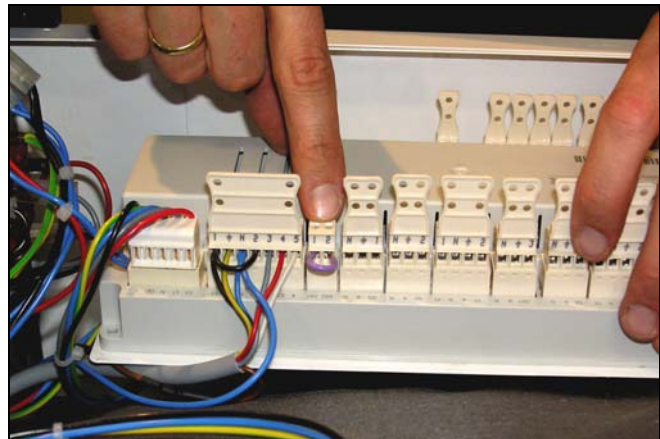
Überprüfen Sie, ob in dem Stecker SK1/SK2 die Kabelbrücke vorhanden ist und stecken diesen in den Kesselregler.
